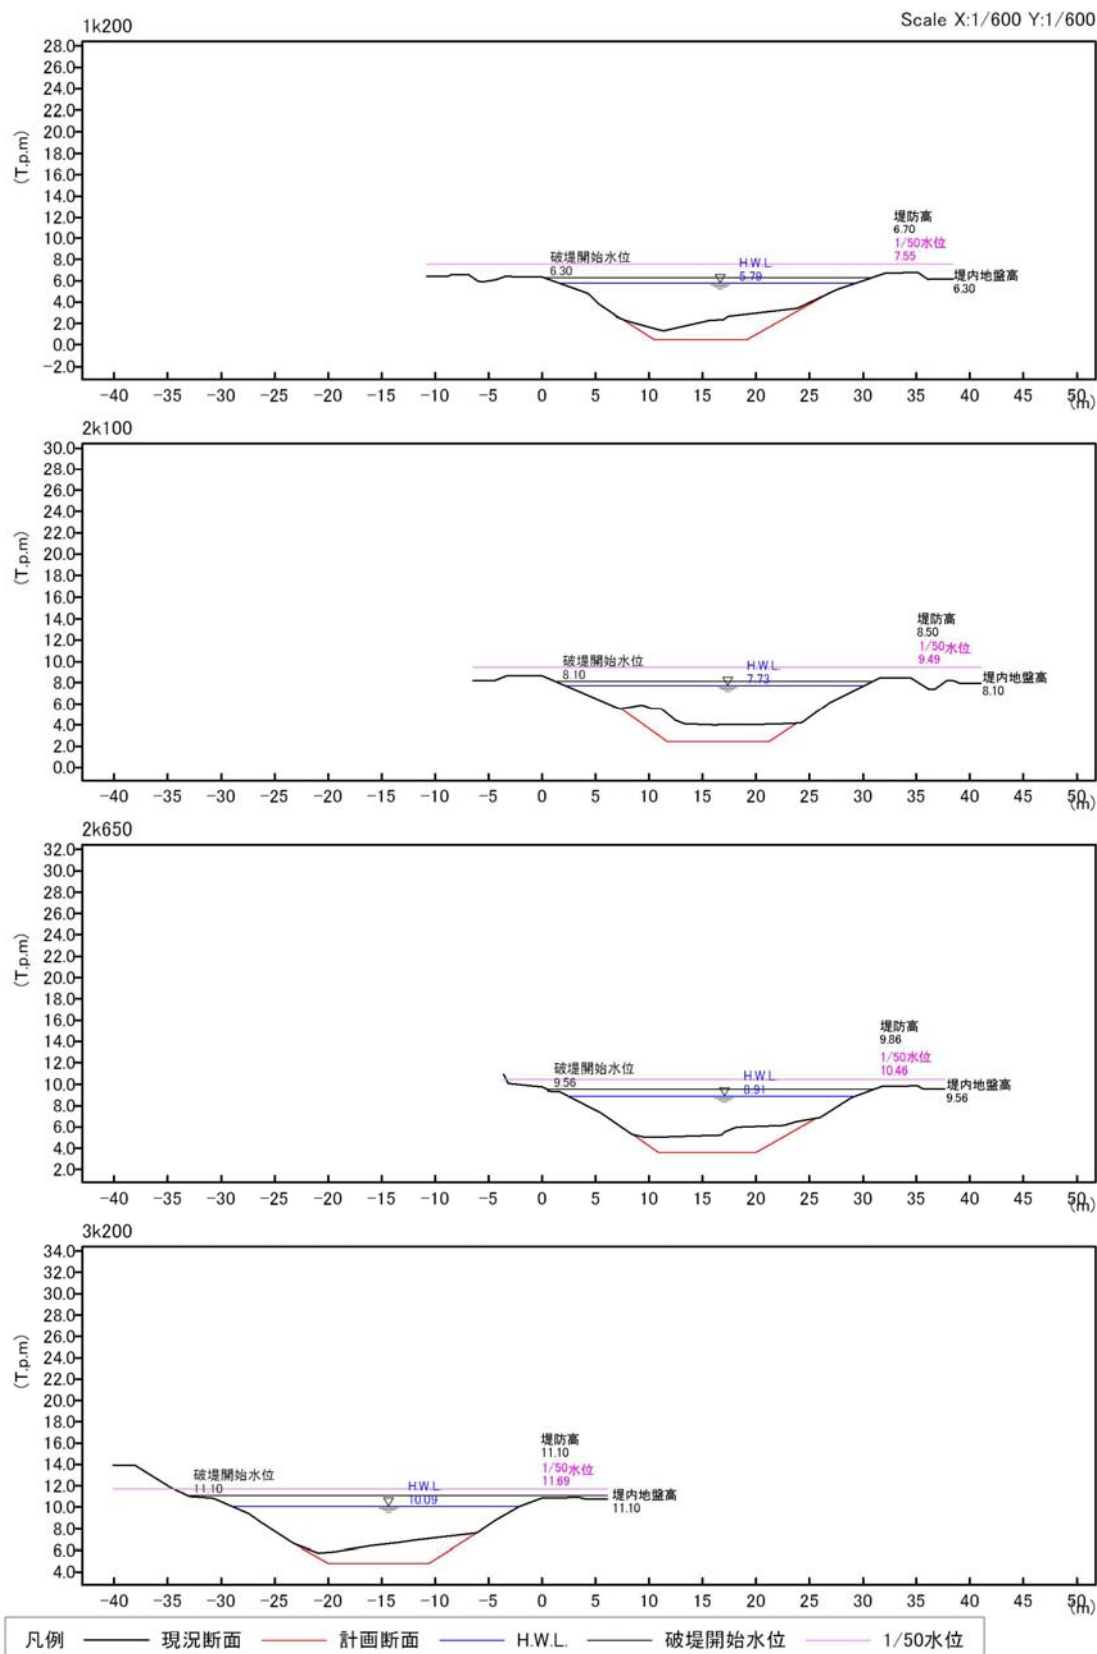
破堤箇所横断面図 都治川右岸 (1/3)
